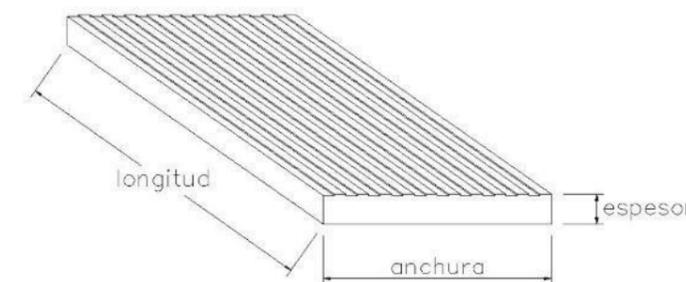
Pavimento táctil de bandas longitudinales. Fuente: Web Granilouro
